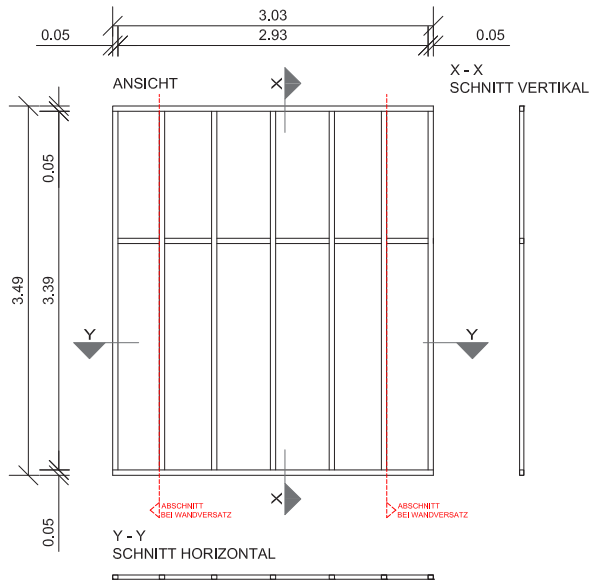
| Hinterlüftete Fassade Unterkonstruktion
